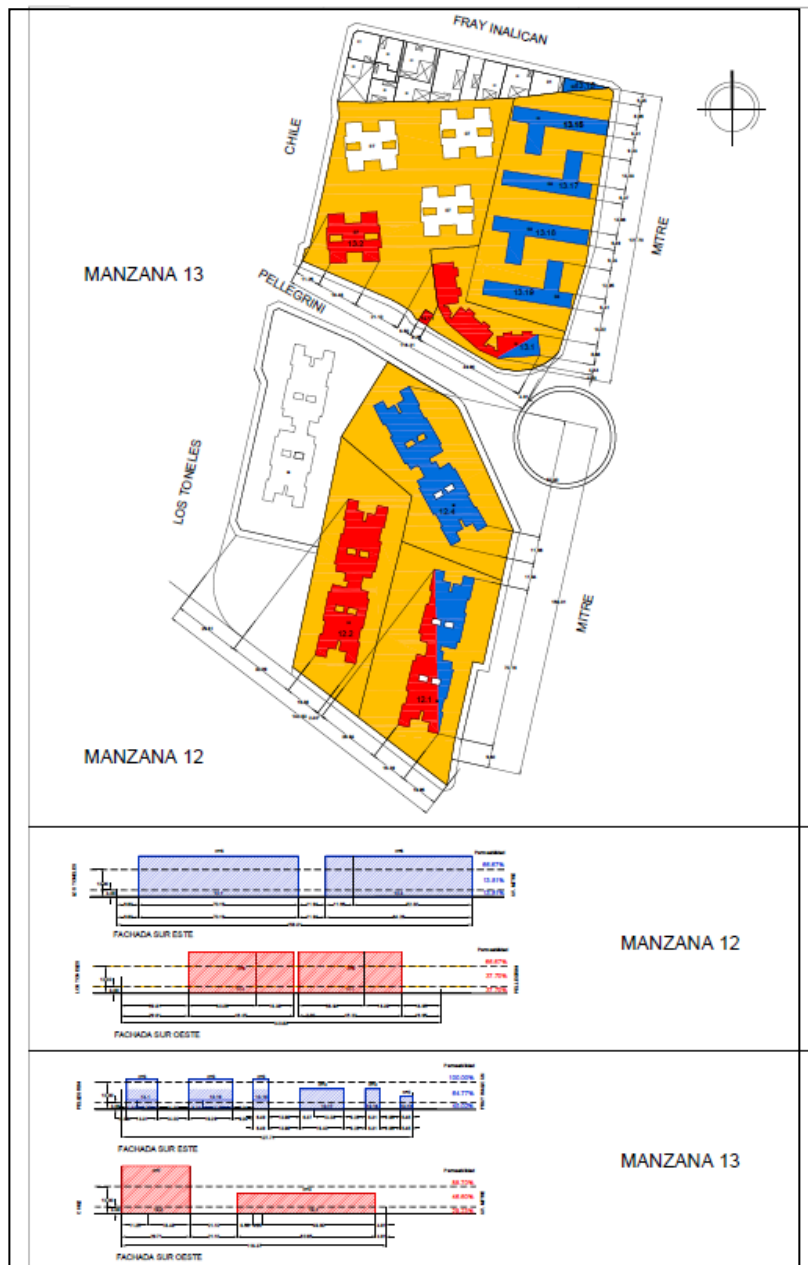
Plano de permeabilidad de fachadas – Manzanas 12 y 13 – Zona Pellegrini
